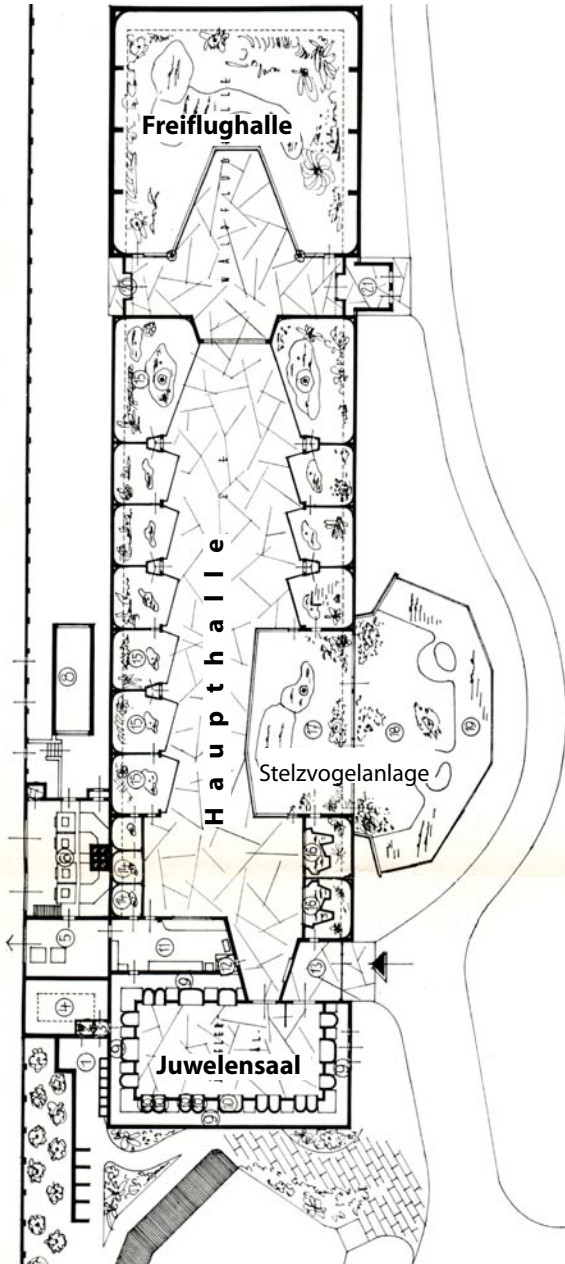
Grundriss der Faust-Vogelhallen
